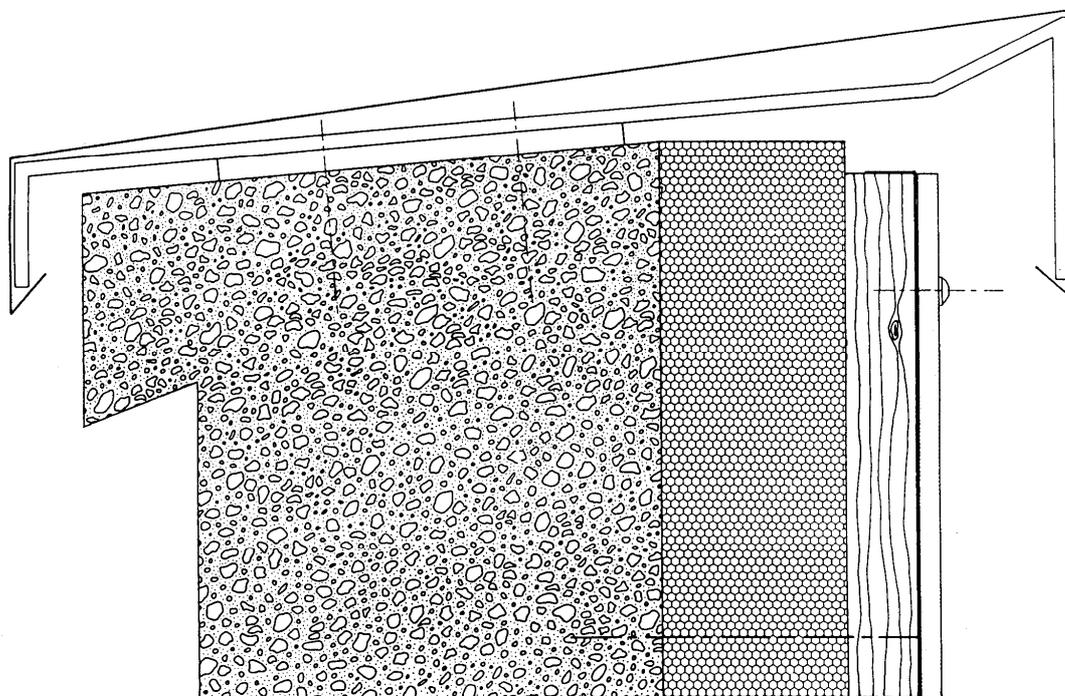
Acrotère – Coupe verticale - Pose en vêtage
